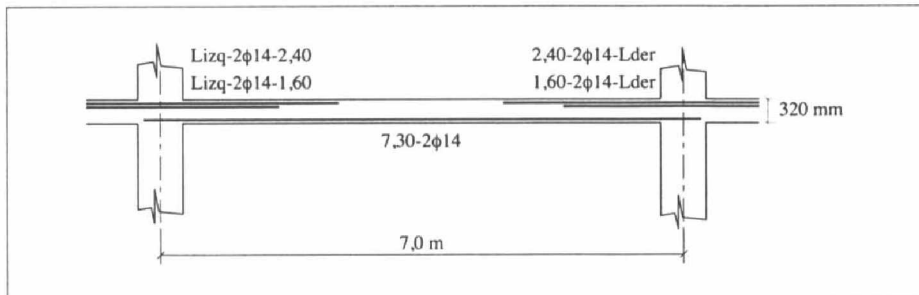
c Armado de cada nervio en banda de pilares
